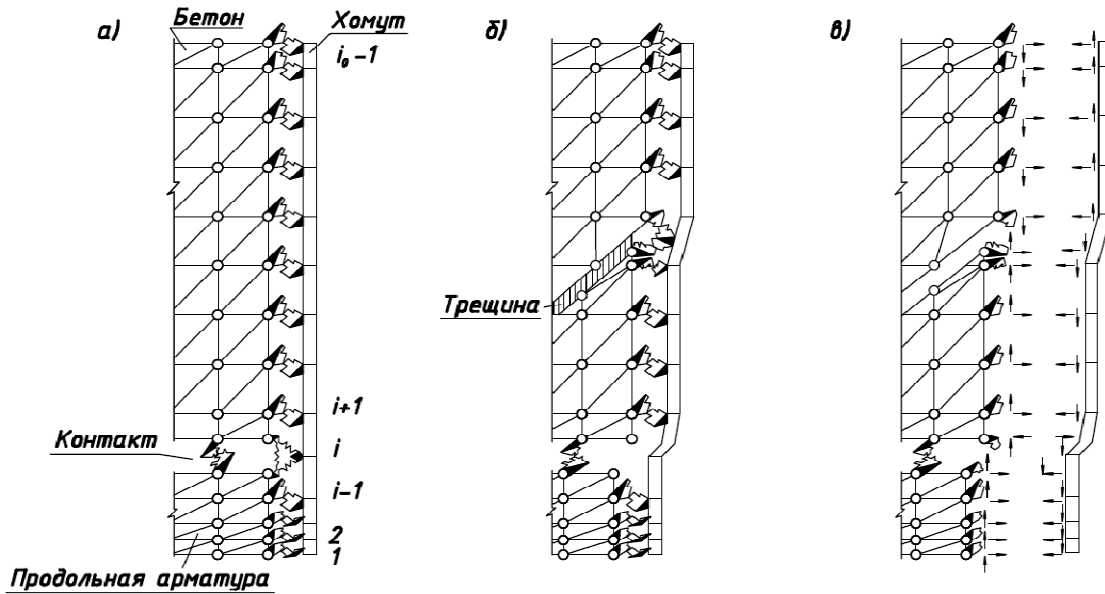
Расчетная схема балки с хомутом: а – поперечный разрез балки без трещин; б – поперечный разрез балки с трещиной; в – расчленение на отдельные подсистемы
